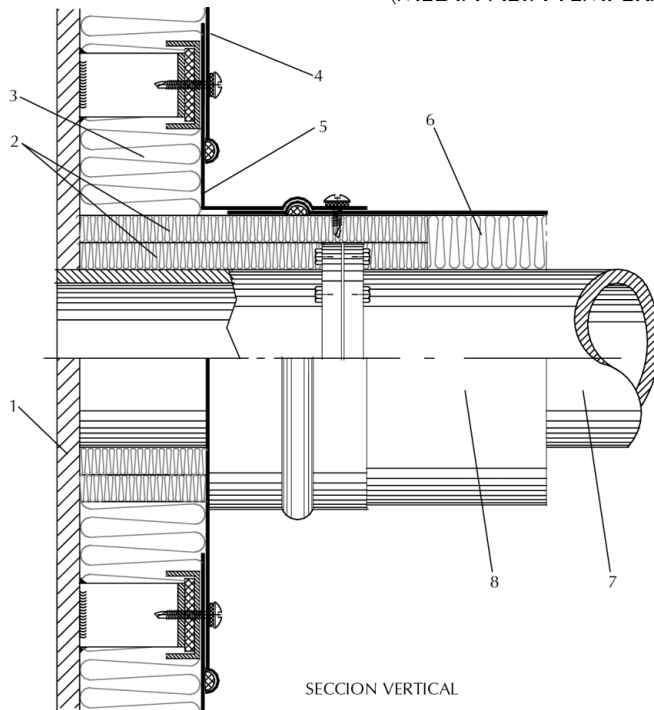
Figura Q: Detalle aislamiento de armadura y refuerzos de equipos.
